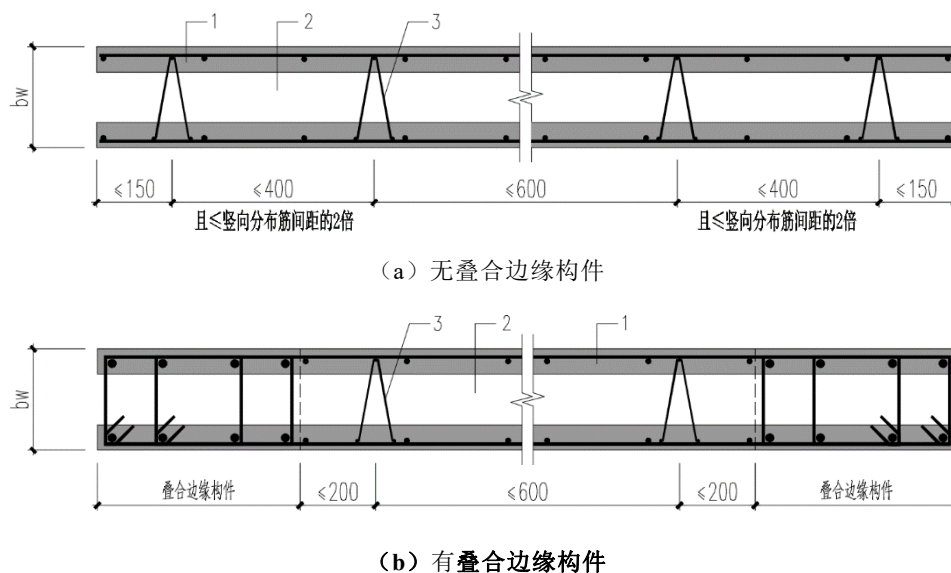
双面叠合剪力墙板钢筋桁架布置示意图
